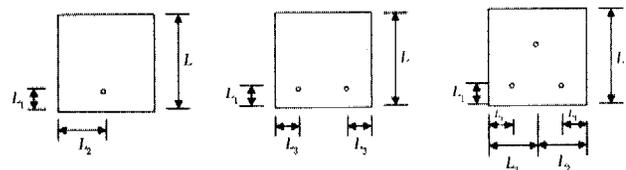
混凝土试件中内置不同根数玻璃管的横截面示意图
